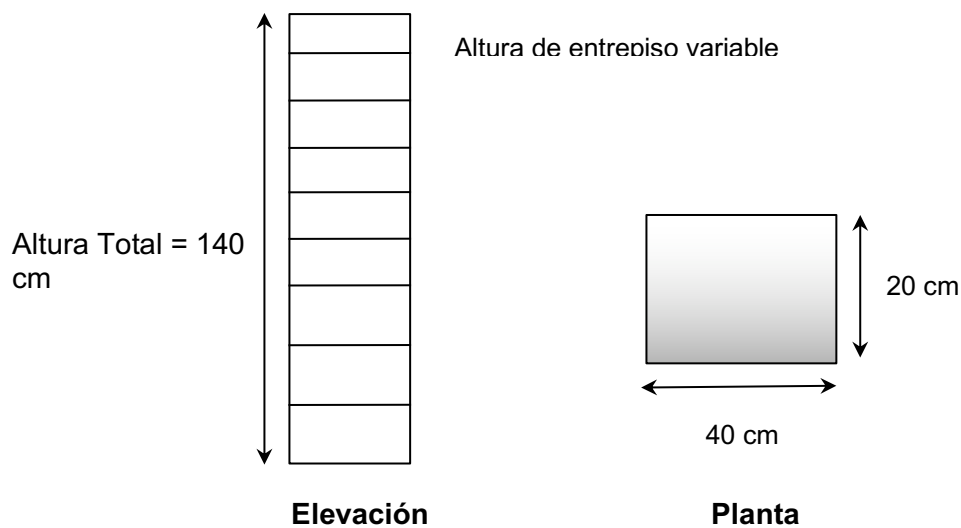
Vistas en planta y elevación del edificio, acotaciones en cm.
